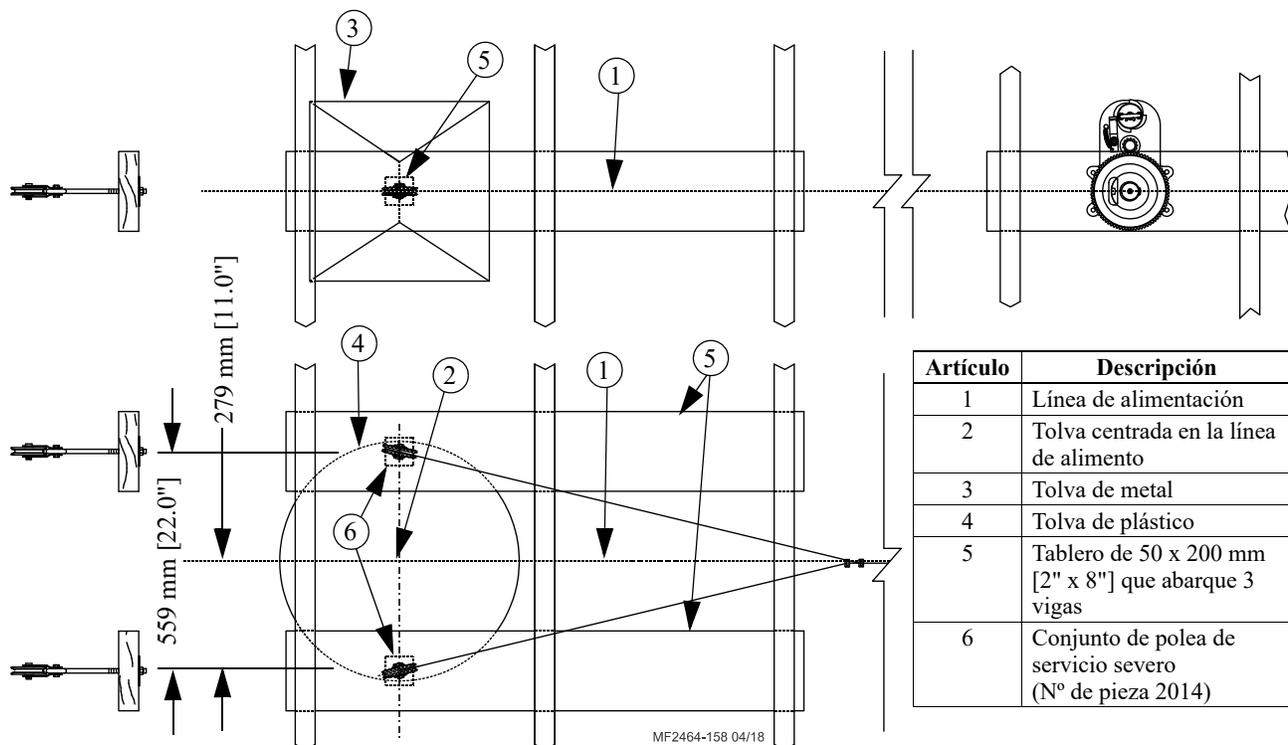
Instalación de cables en ubicaciones de tolvas (construcciones de madera)
